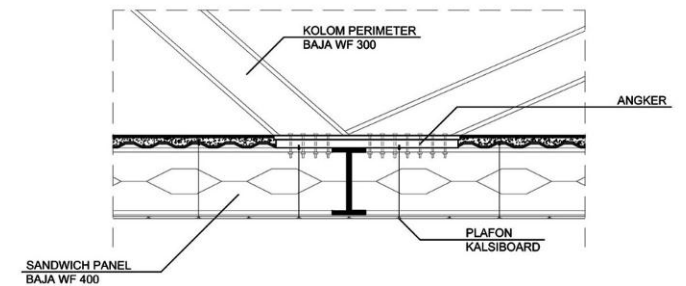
Sistem penyaluran beban di ruang dalam bangunan
